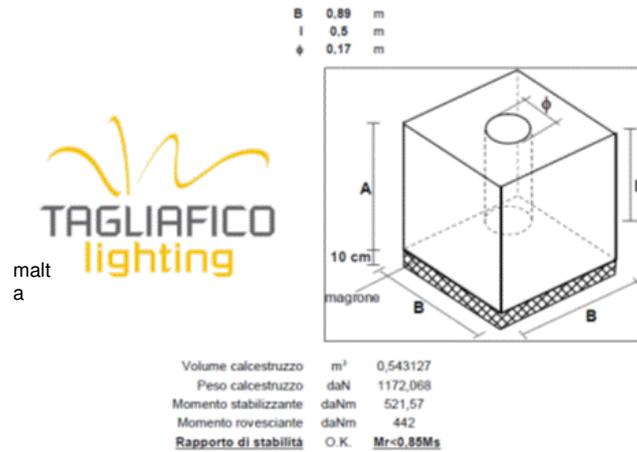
Tipico costruttivo plinto del palo: infissione diretta del palo nel blocco di fondazione
